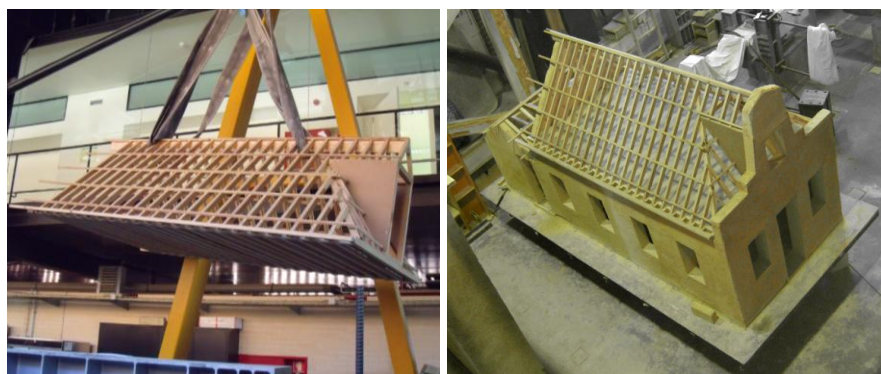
Elevação e aspecto final da estrutura da cobertura.
